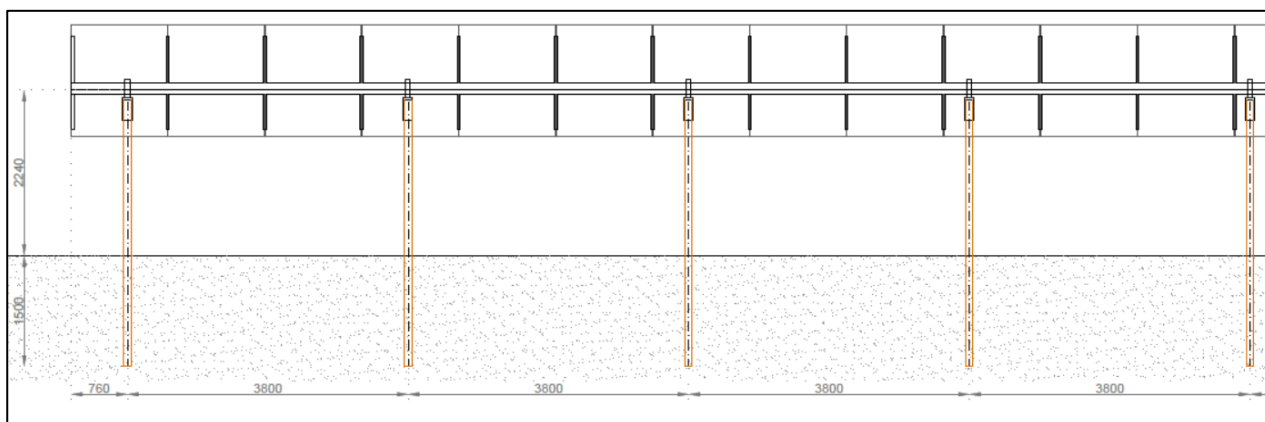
stralcio prospetto struttura di supporto 1x30P-30
